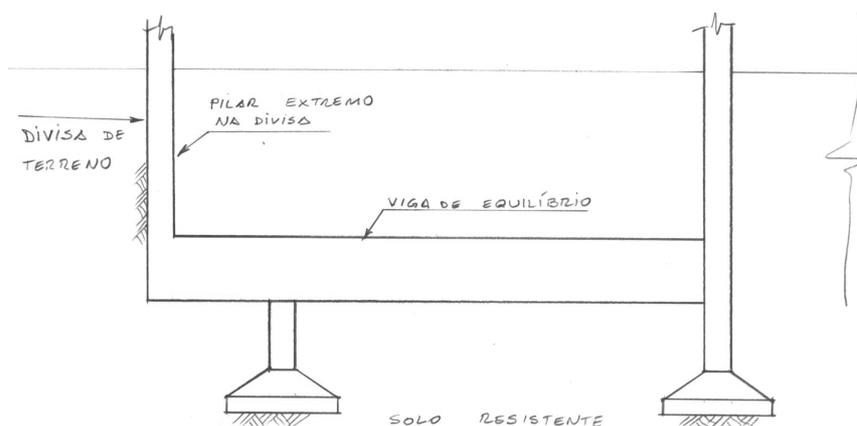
Pilar de Divisa com Viga de Equilíbrio
